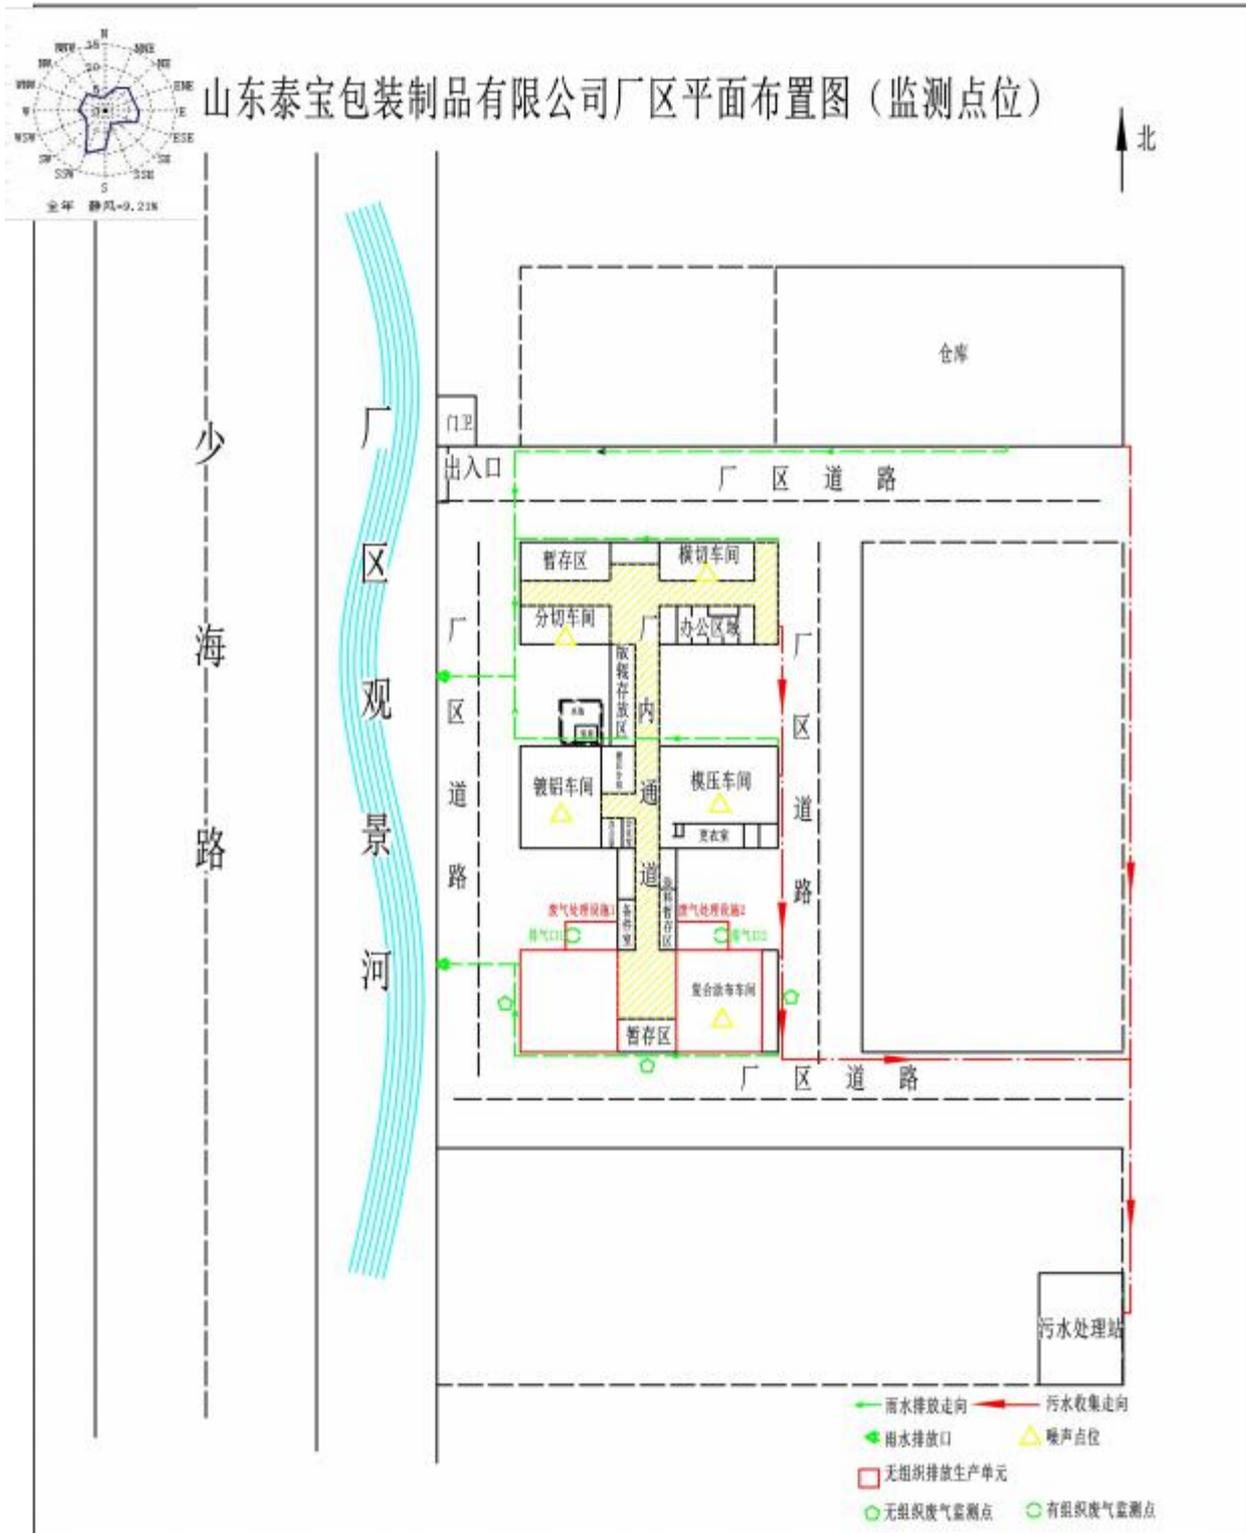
山东泰宝包装制品有限公司厂区平面布置图
